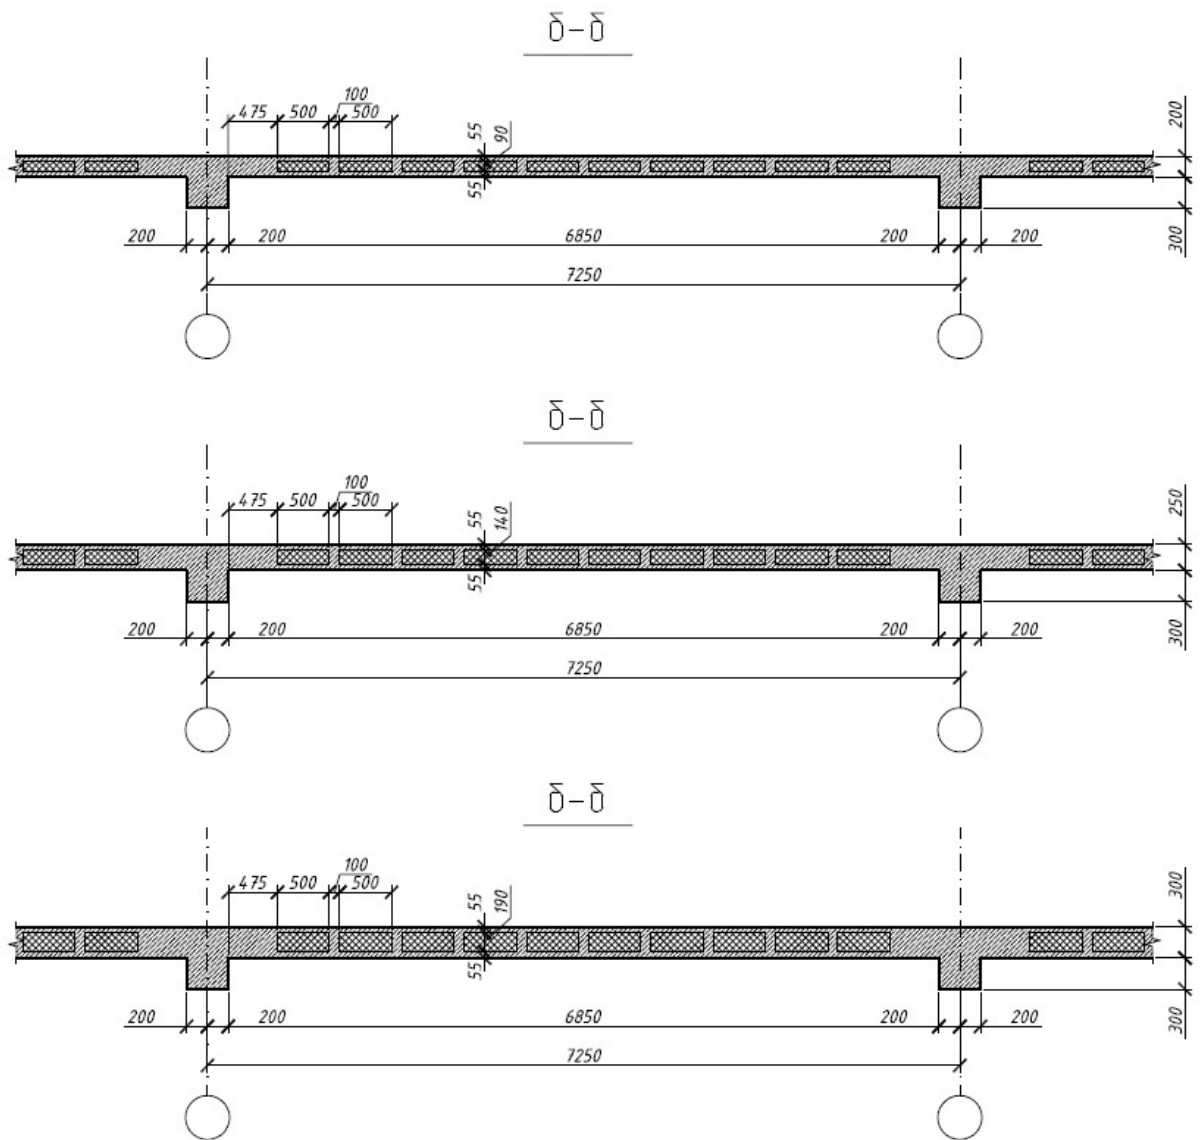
Схема типової комірки плити перекриття будівлі з пустотоутворювачами
